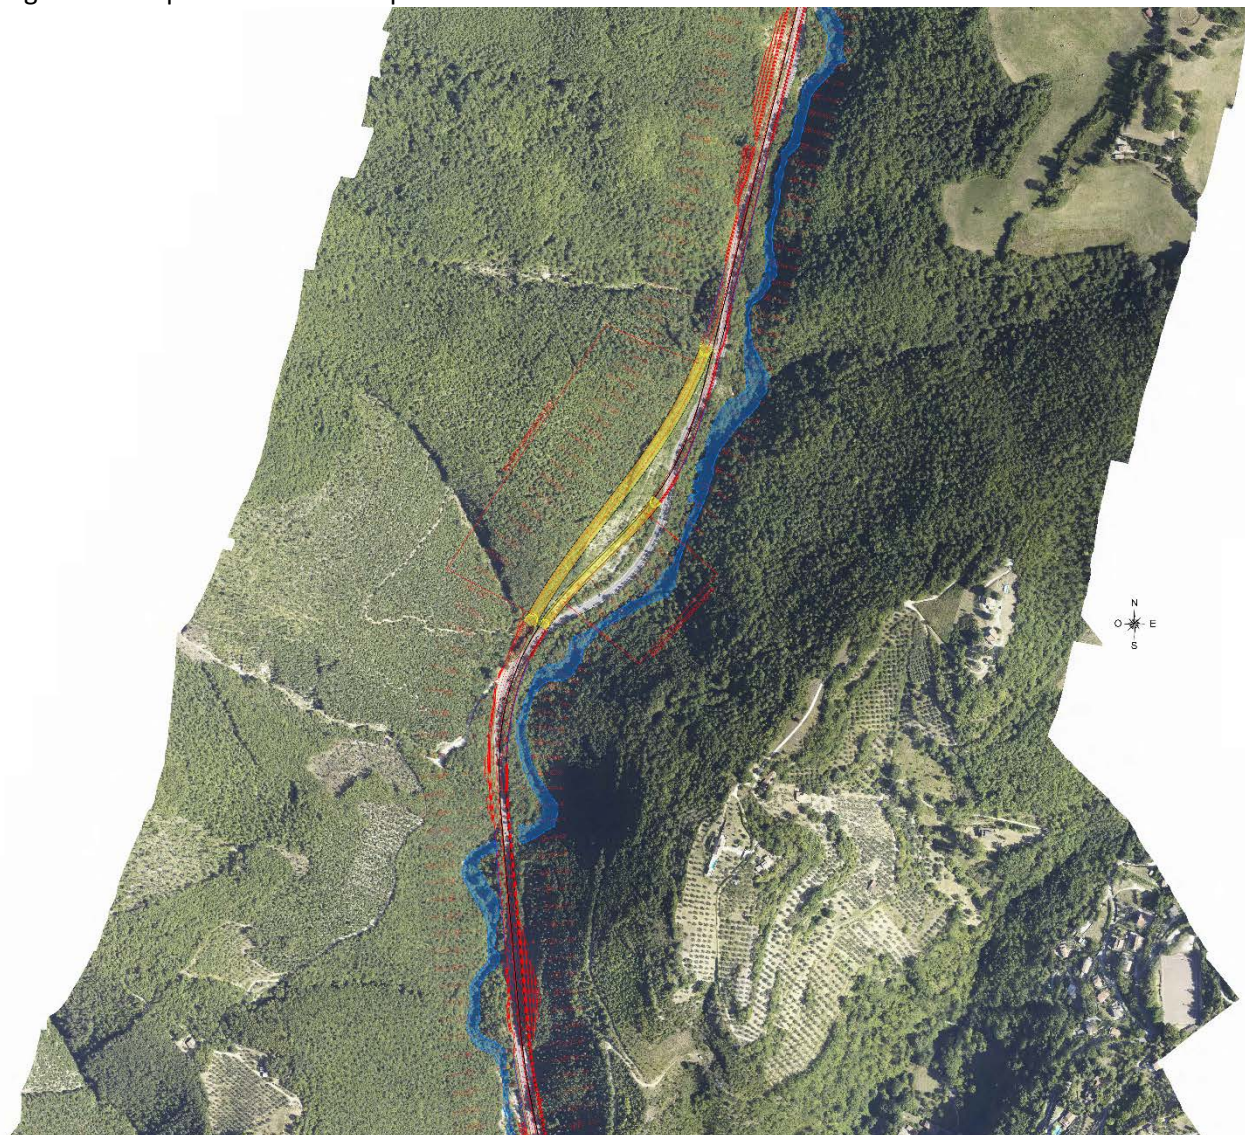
Lotto 1: tracciato di progetto su ortofoto dalla pk 3+300 alla pk 4+800
